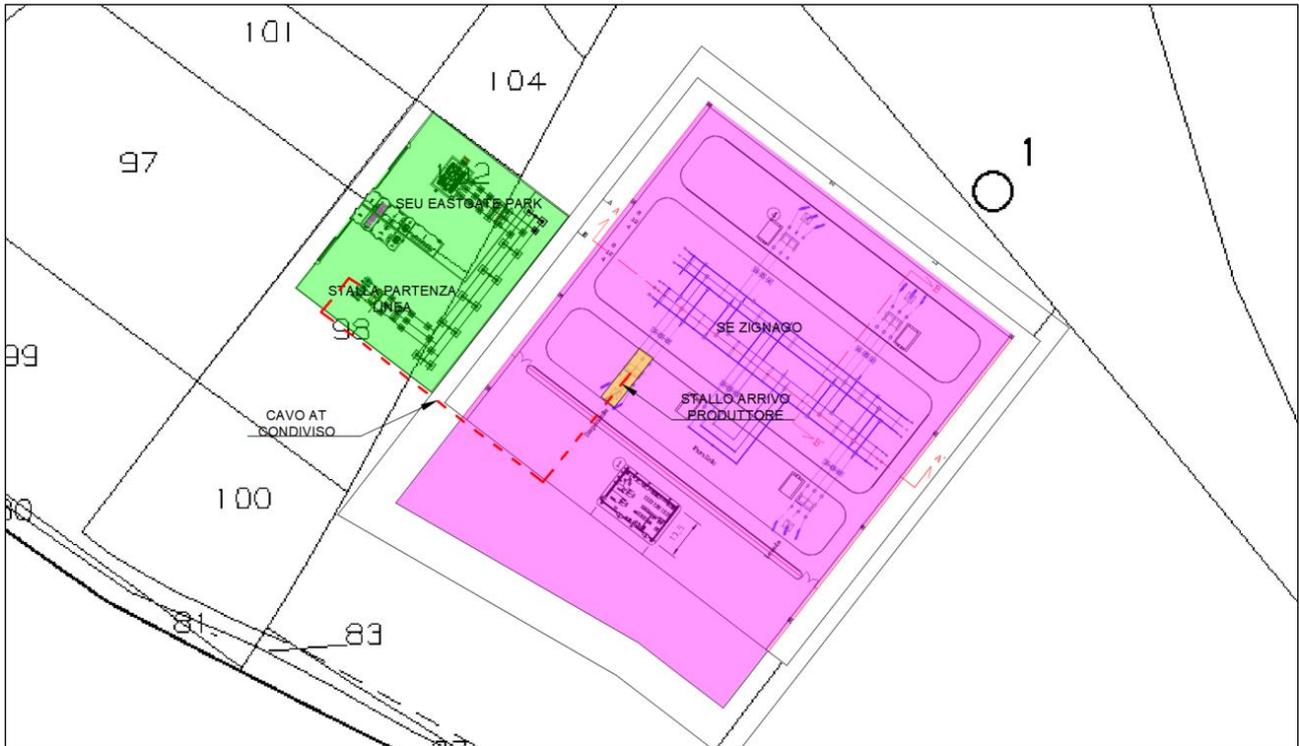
Planimetria elettromeccanica stazione elettrica condivisa
